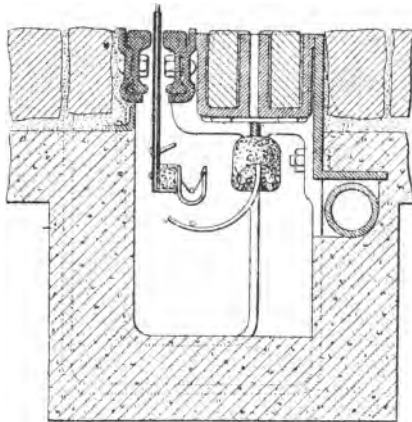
Caniveau à conducteur flexible, système Waller-Manville.
